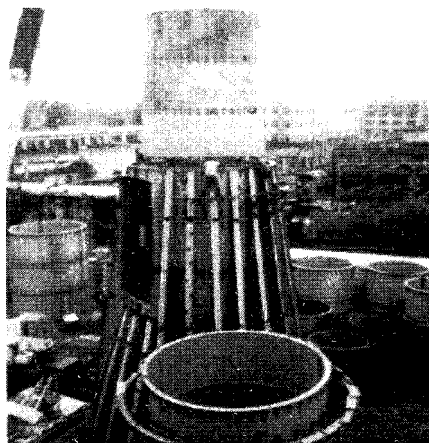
Монтаж предварительно укрупненного блока дымовой трубы, состоящего из трех царг. На переднем плане — подготовленный к установке очередной блок с монтажной площадкой на кронштейнах
